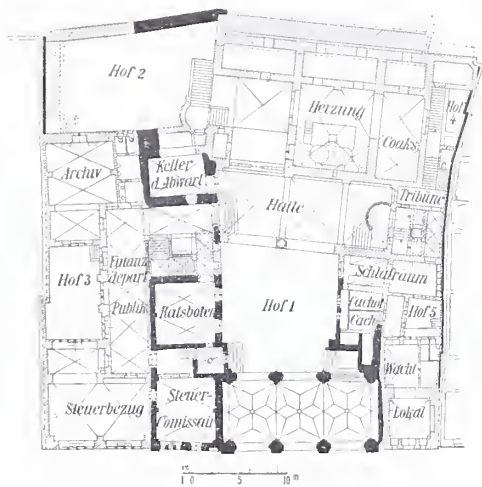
Erdgeschoss-Grundriss 1:800.
